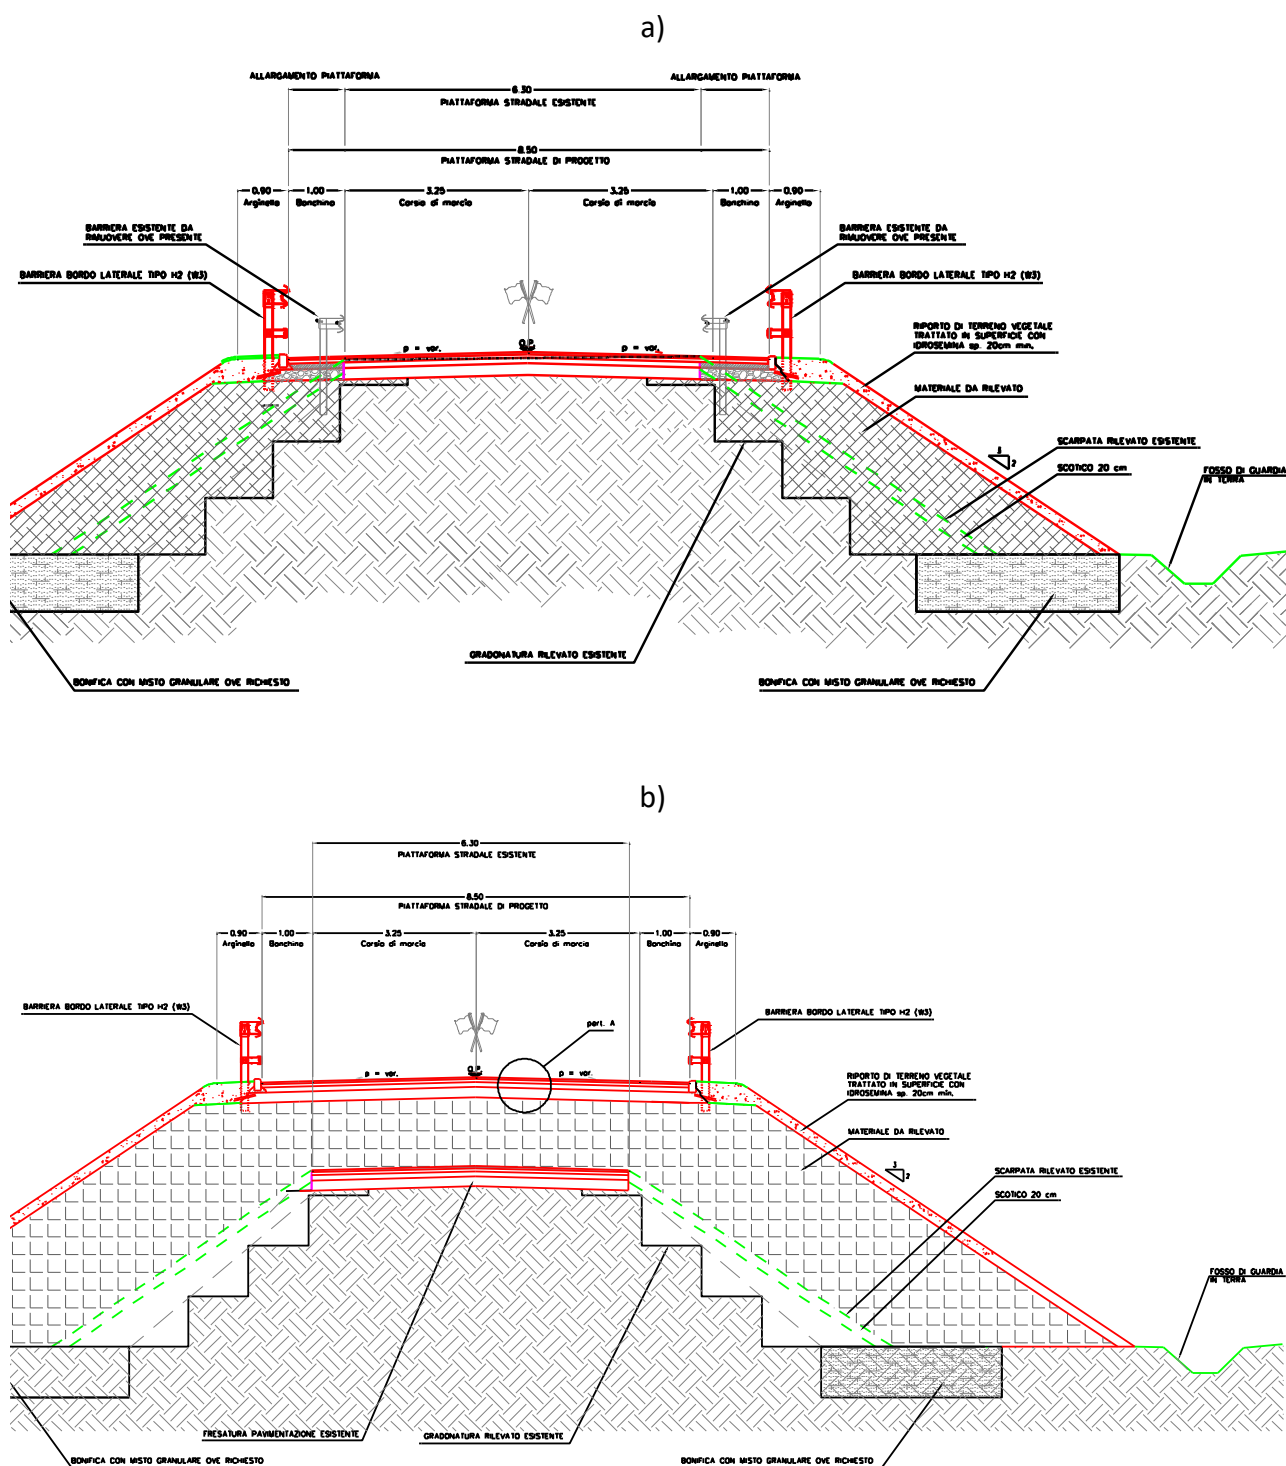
a) Sezione tipo in ampliamento; b) Sezione tipo nuova sede stradale
